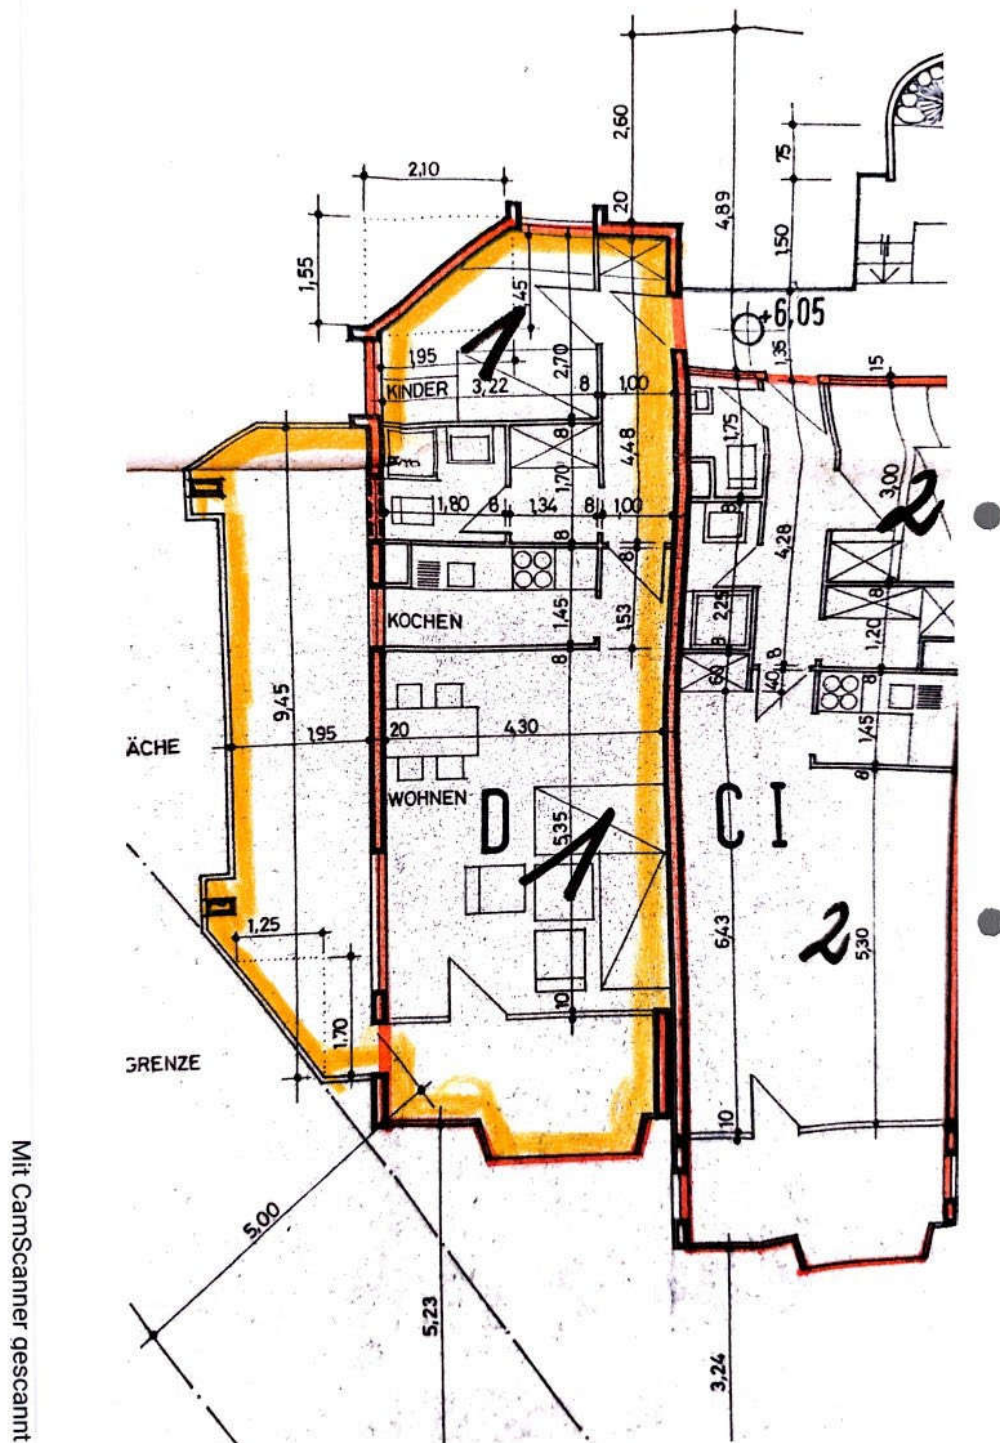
Teilgrundriss Erdgeschoss mit Kennzeichnung Bewertungsobjekt
